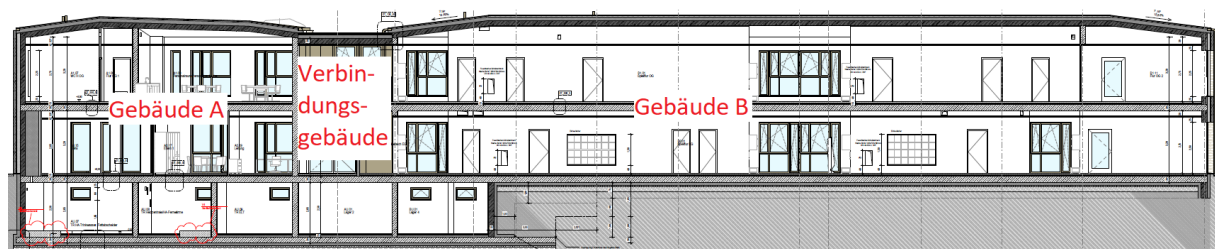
Schnittdarstellung aus Architektenwerkplan mit Gebäudebezeichnungen und Geschossübersicht
